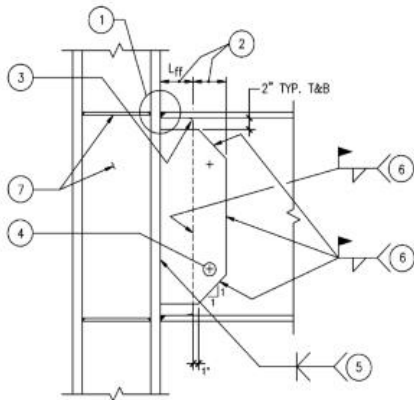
Conexión soldada de aleta libre. (Welded
